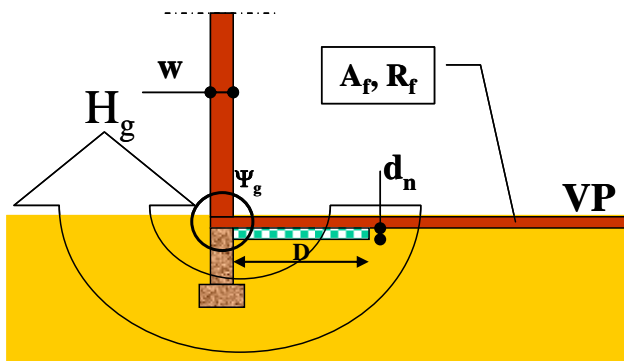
Représentation schématique d'un plancher sur terre-plein
